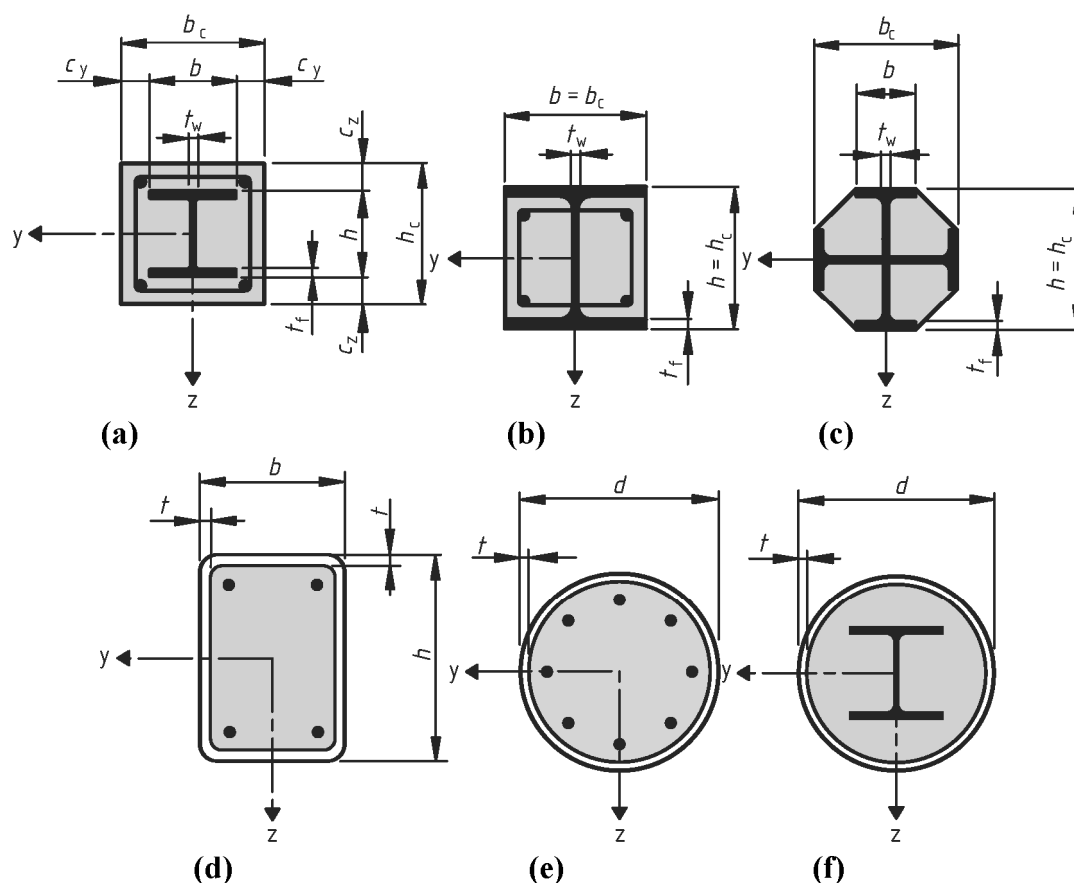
Secciones tipo de pilares mixtos y símbolos
